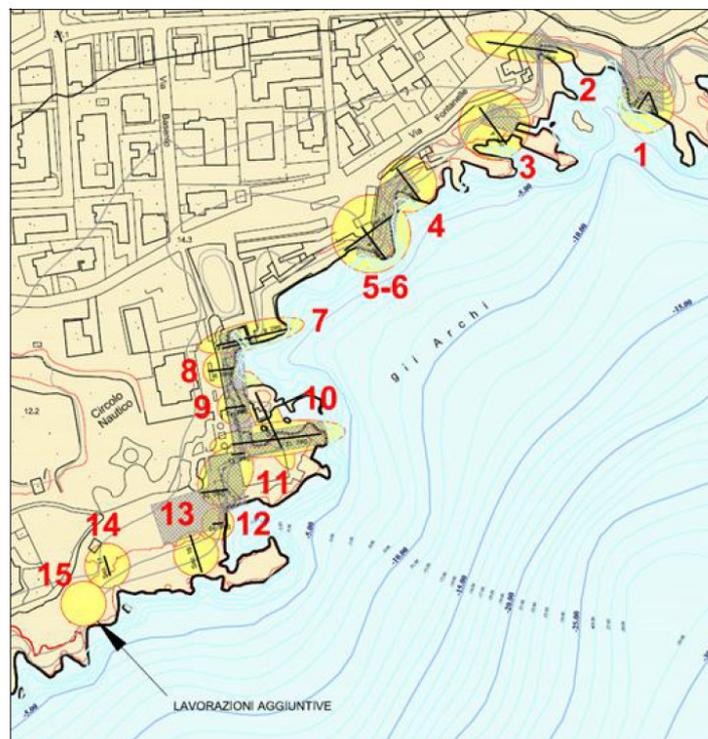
Planimetria con indicazione dei siti oggetto di intervento definiti dal progetto definitivo
